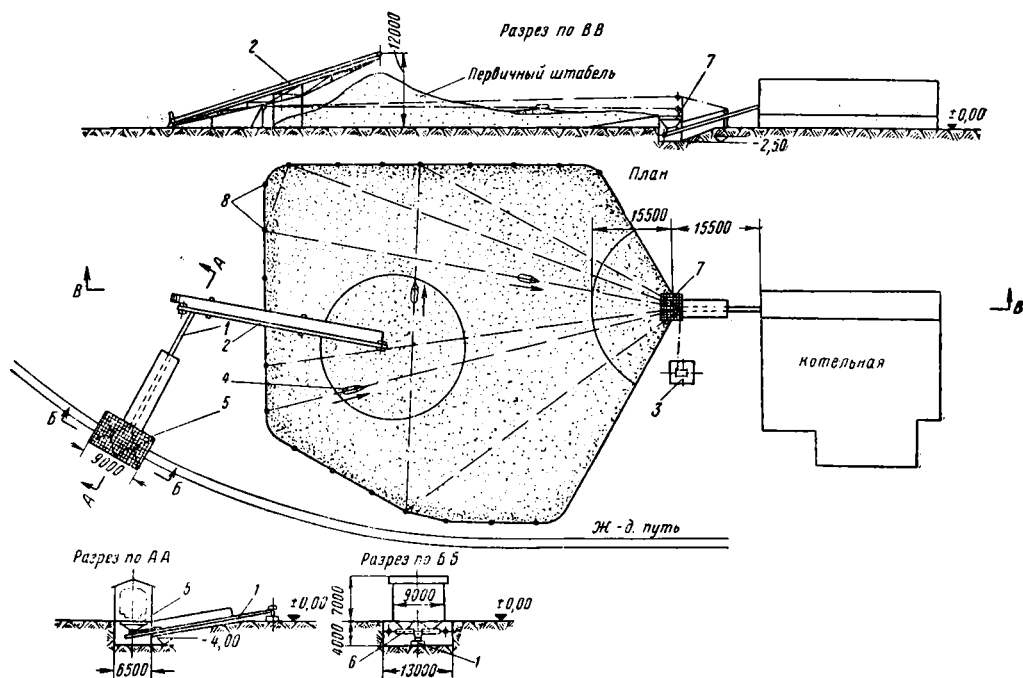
Базисный склад топлива, обслуживаемый передвижным ленточным конвейером и автопогрузчиком (схема С-4): 1—разгрузочная эстакада; 2—передвижной ленточный конвейер; 3—автопогрузчик; 4—приёмное устройство топливоподачи
